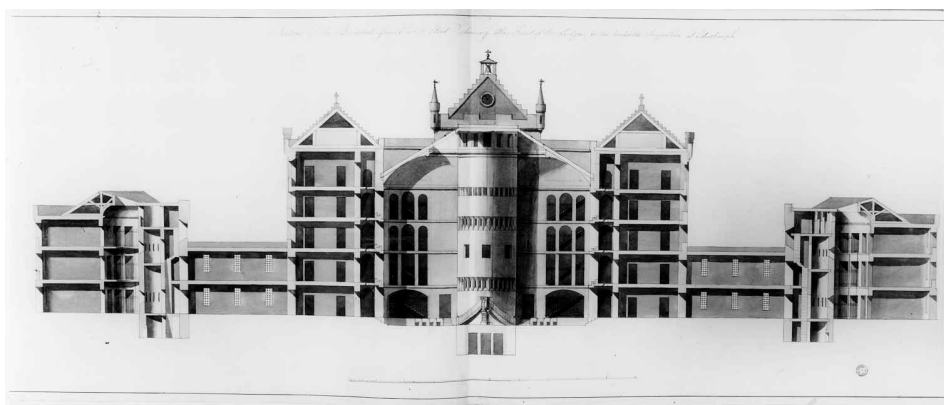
Alzado del diseño de Adam para la Bridewell, donde se observa la torre central de inspección.
